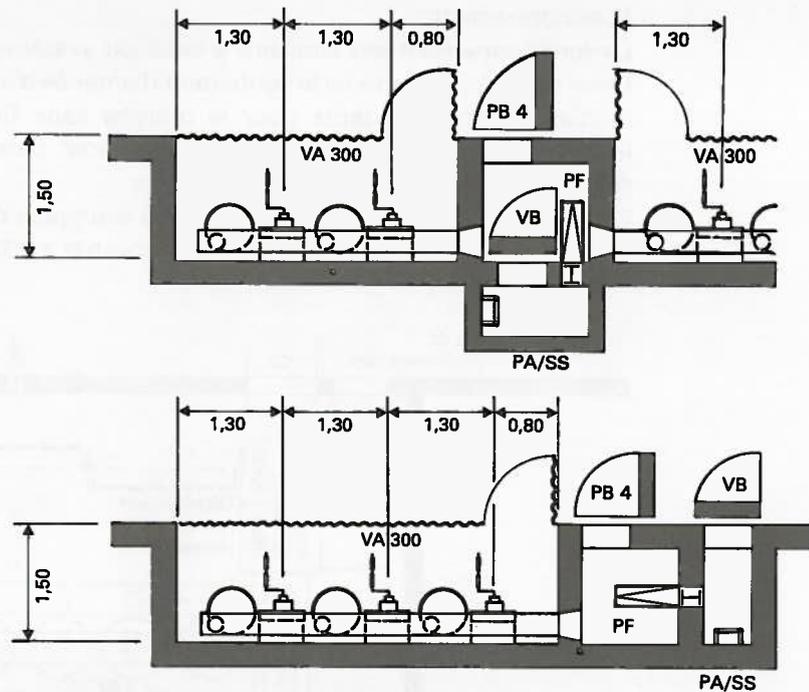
Installation de VA 300 en série dans des niches murales (plan)
